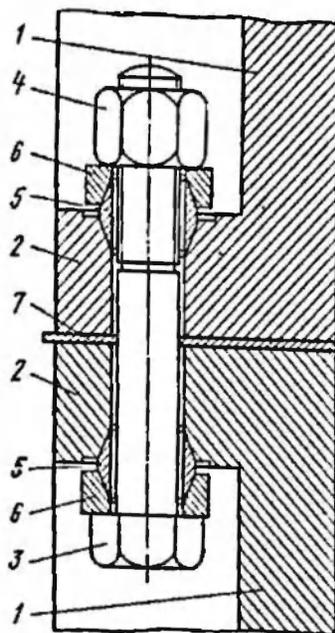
Соединительный болт со свинцовыми бочкообразными шайбами:
